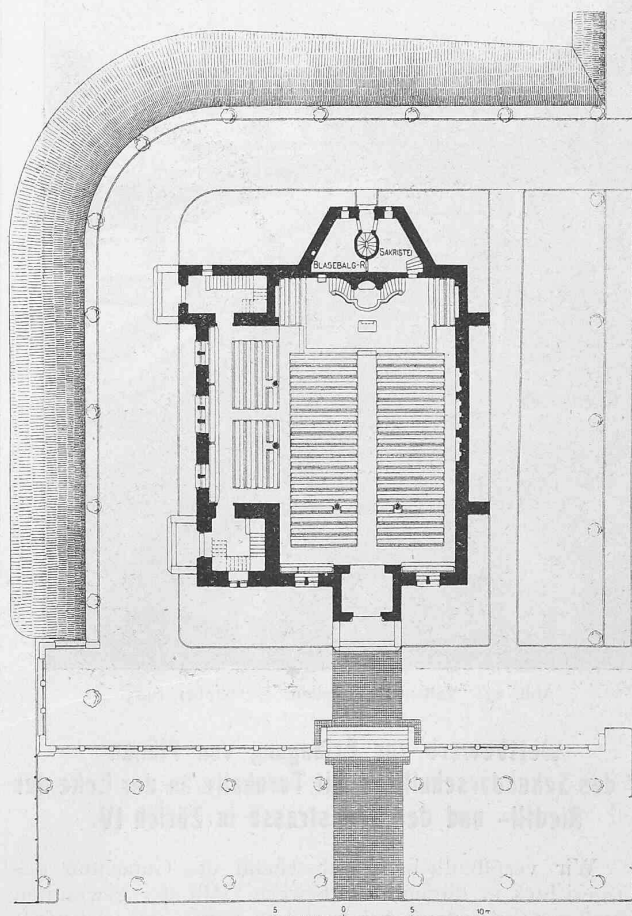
Grundriss vom Erdgeschoss. — Masstab 1:500.
